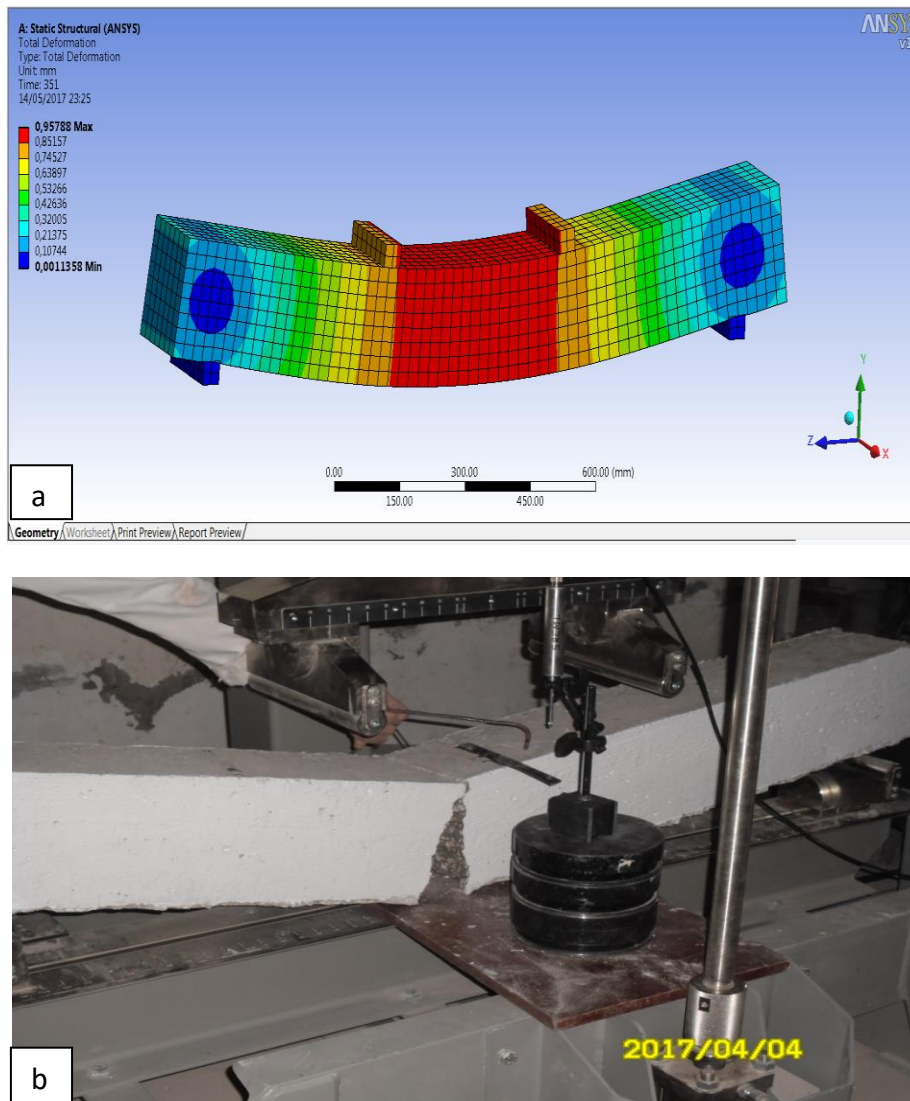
, b : La déformation de la poutre non\_ armée, a) poutre numérique, b) poutre expérimentale.
